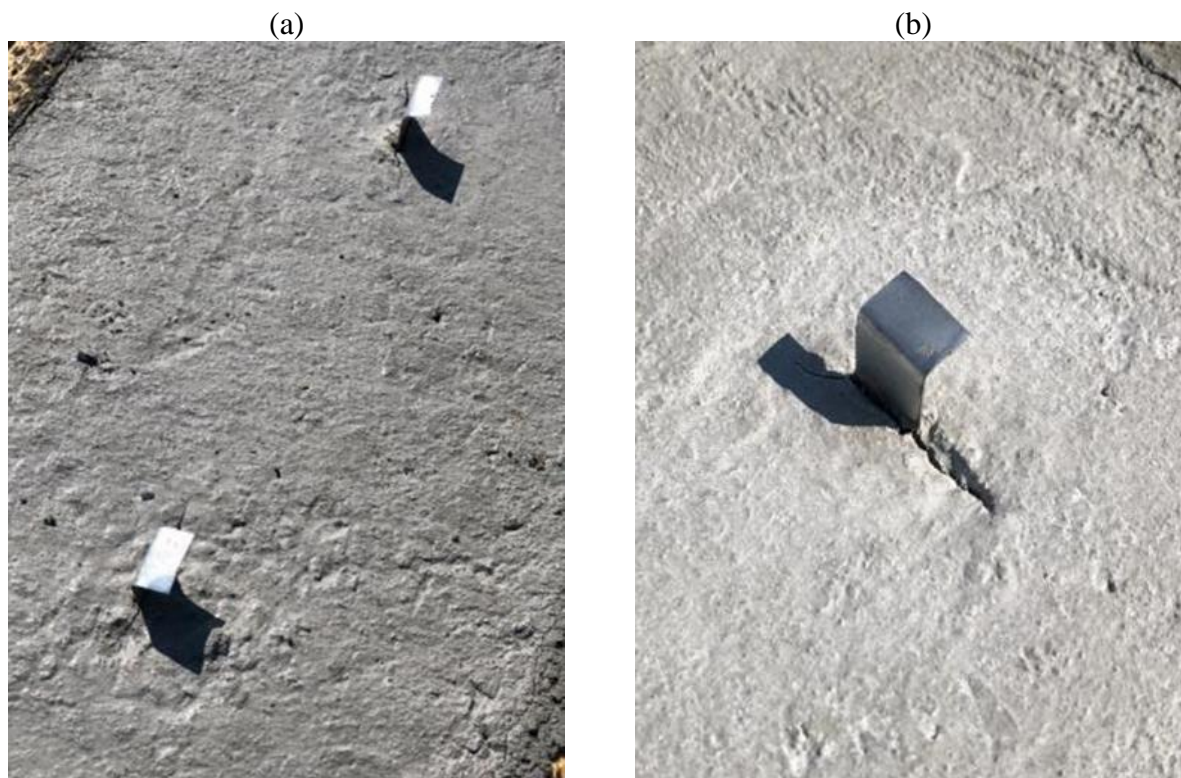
Láminas de inducción de grietas: (a) panel con dos láminas, (b) lámina en detalle.
